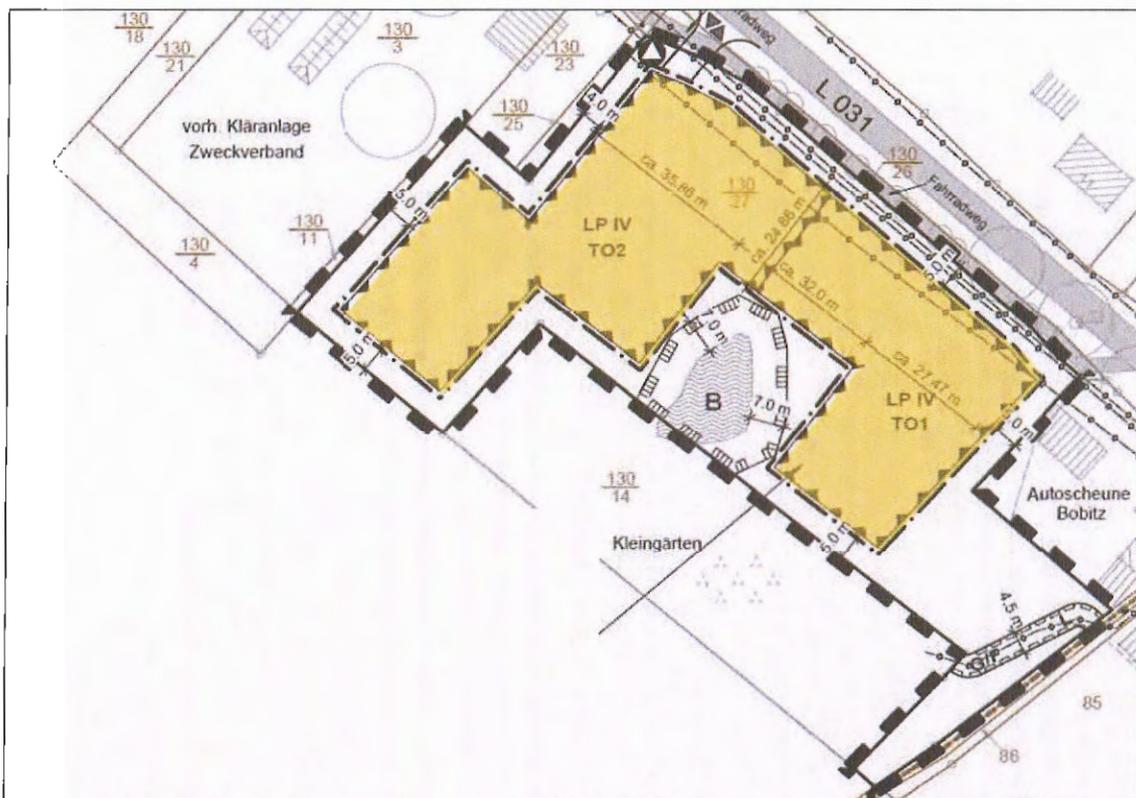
Vorhaben im Zusammenhang mit Eingriffen in Lebensräume. Orange Flächen: Baufeld; in diesem Bereich Anlage von Gebäuden o.a. Gewerbeflächen möglich. Kartengrundlage: B.-Plan Entwurf bab Wismar.
